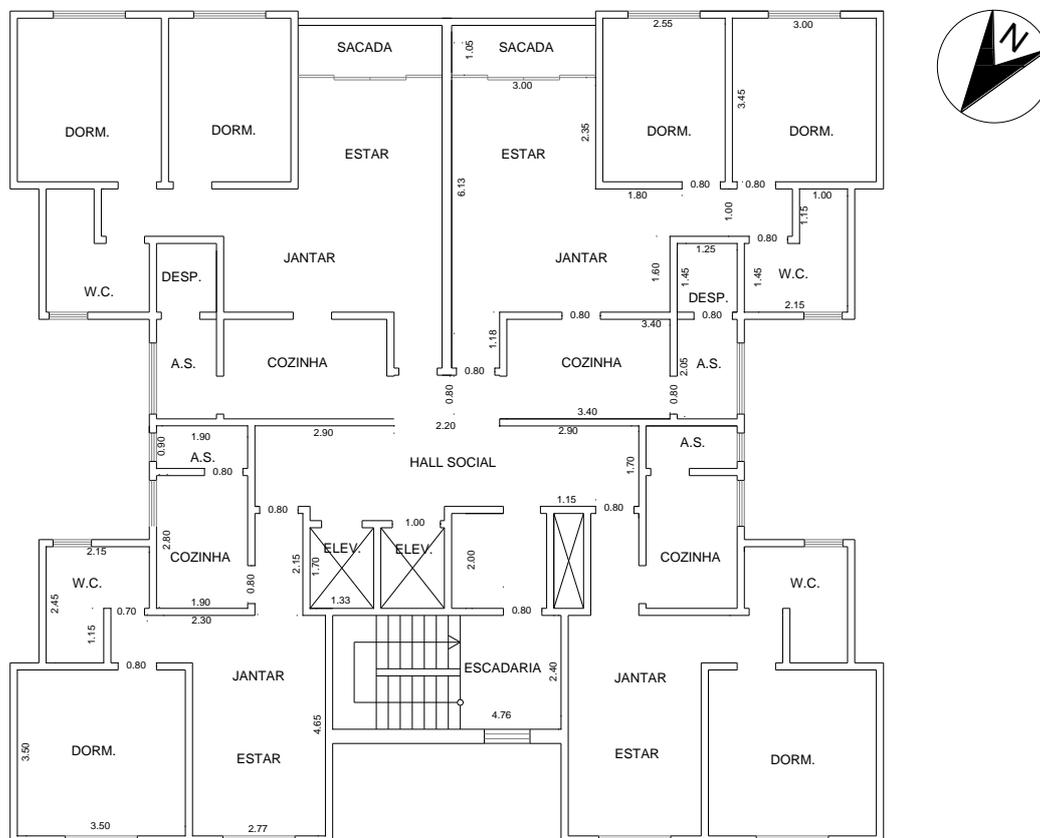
Planta do pavimento-tipo – Residencial Navarro.
